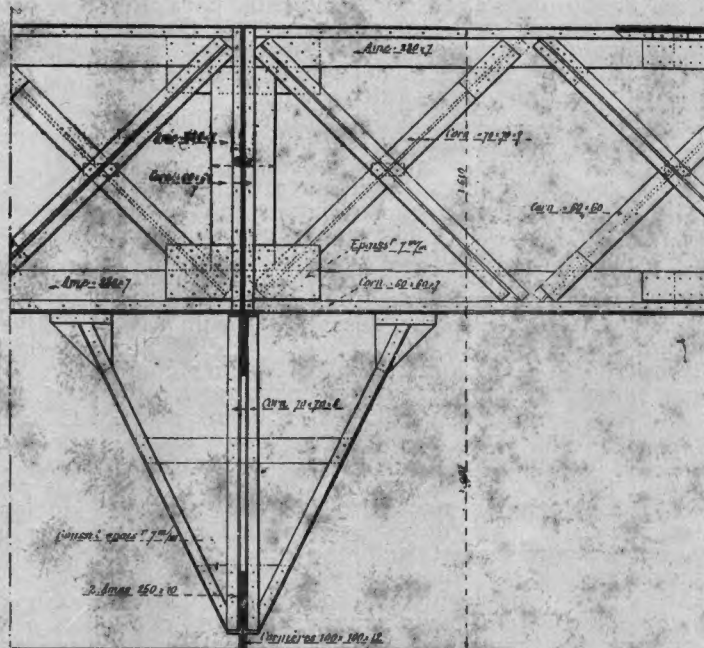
Elevación de una viga y corte transversal de un tabique
